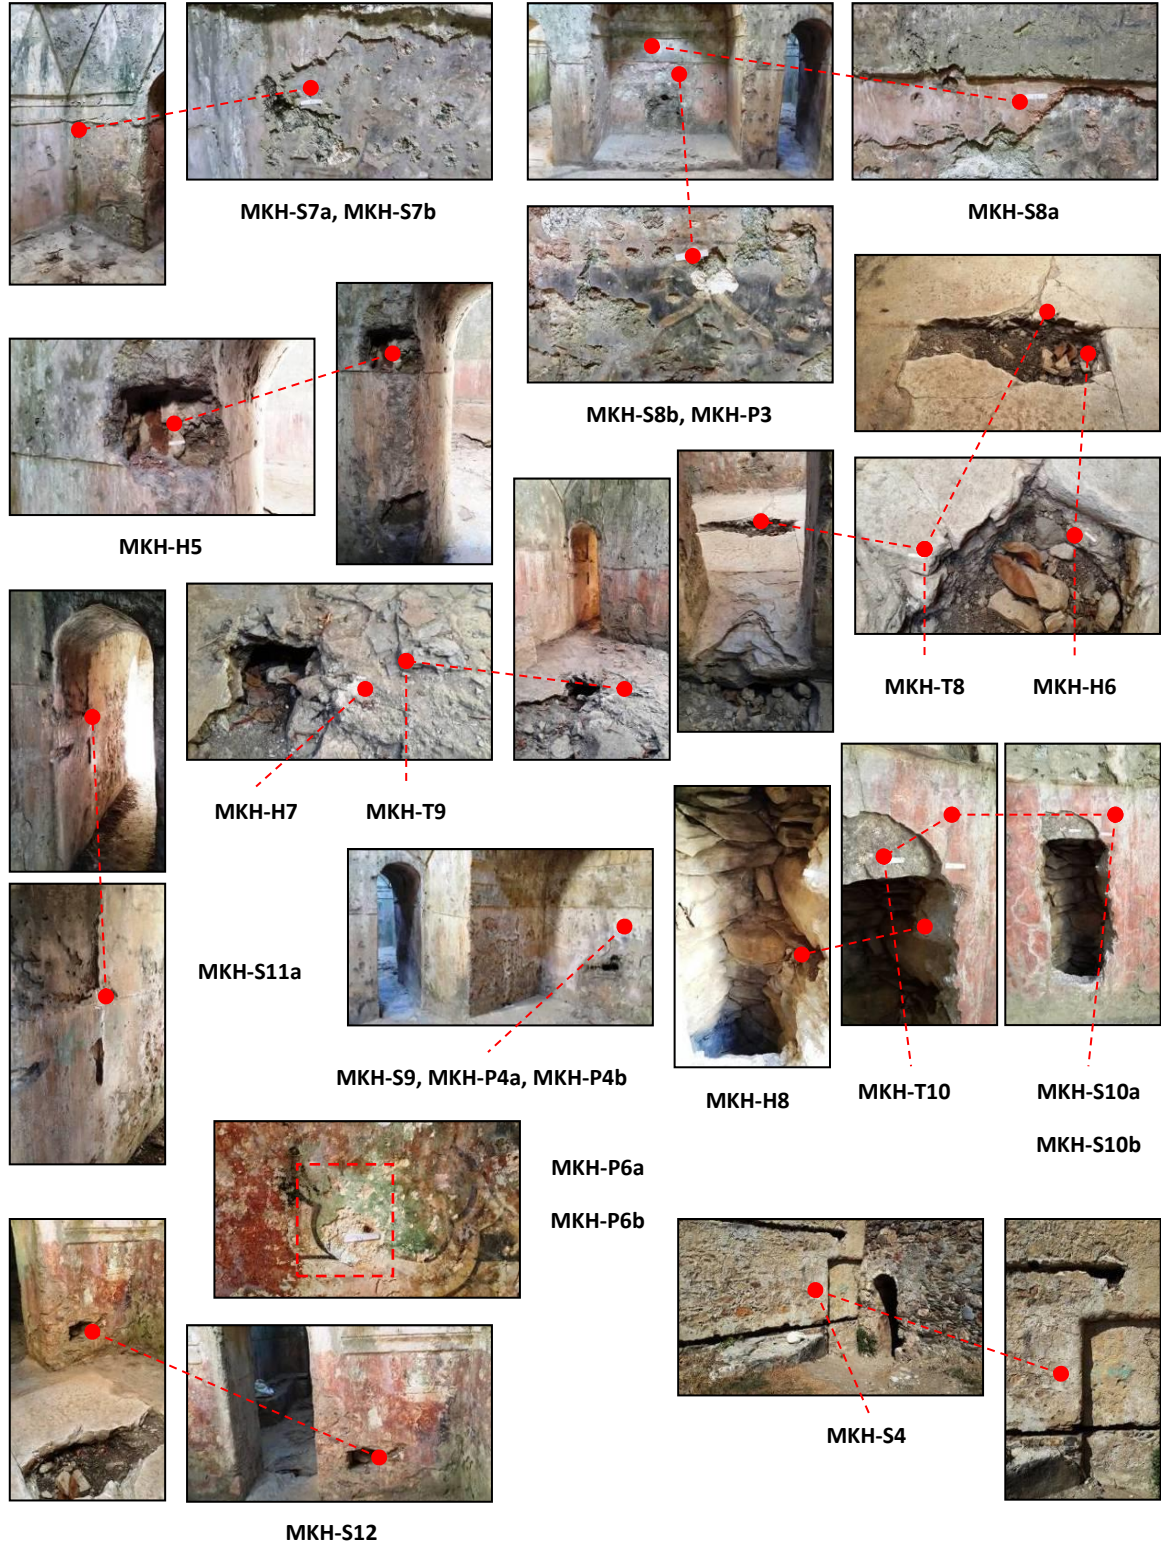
(devam) Mamure Hamamı örneklemeleri (MAKLAB Arşivi)
